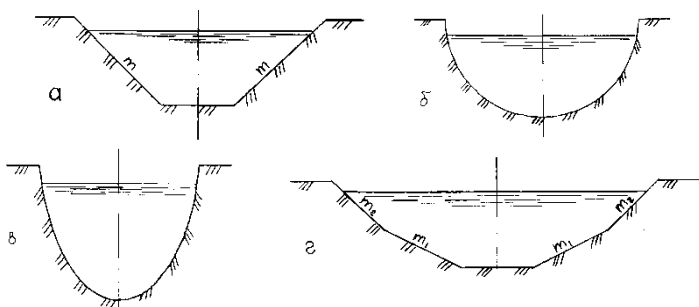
Поперечные сечения мелиоративных каналов: *а* – трапецидальное; *б* – круглое; *в* – параболическое; *г* – полигональное
